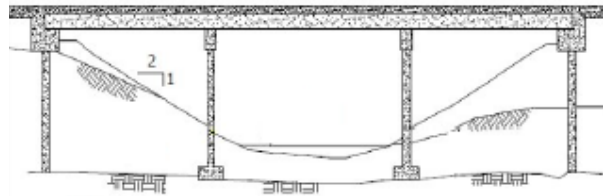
Puente tablero mixto (Fuente: Aranis)
